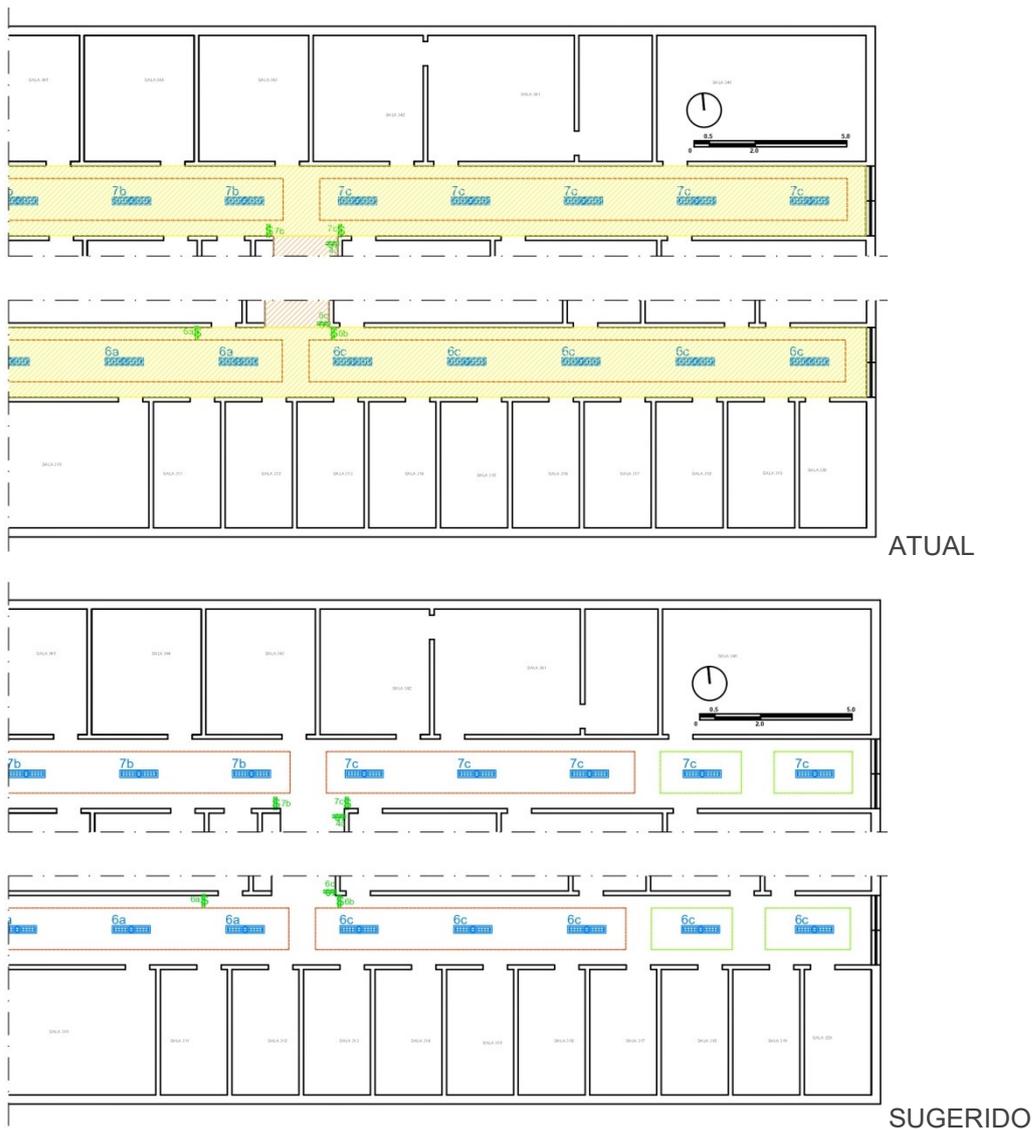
Planta de distribuição dos sistemas de acionamento e iluminação da circulação de salas no 2º pavimento. Fonte: Redesenho dos autores.
